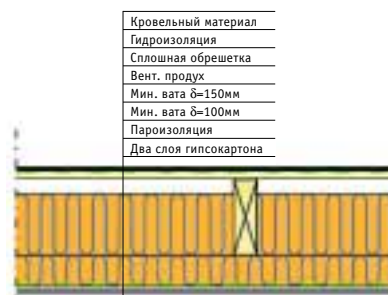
Образец конструкции покрытия и перекрытия мансардного этажа
